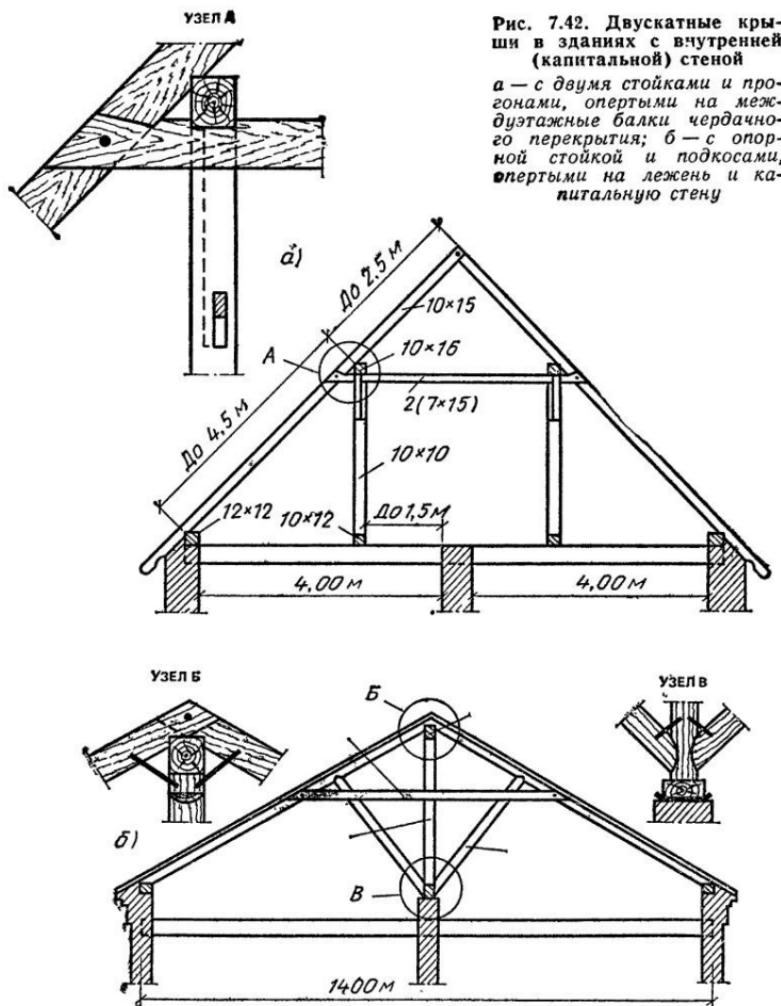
Двускатные крыши в зданиях с внутренней (капитальной) стеной
